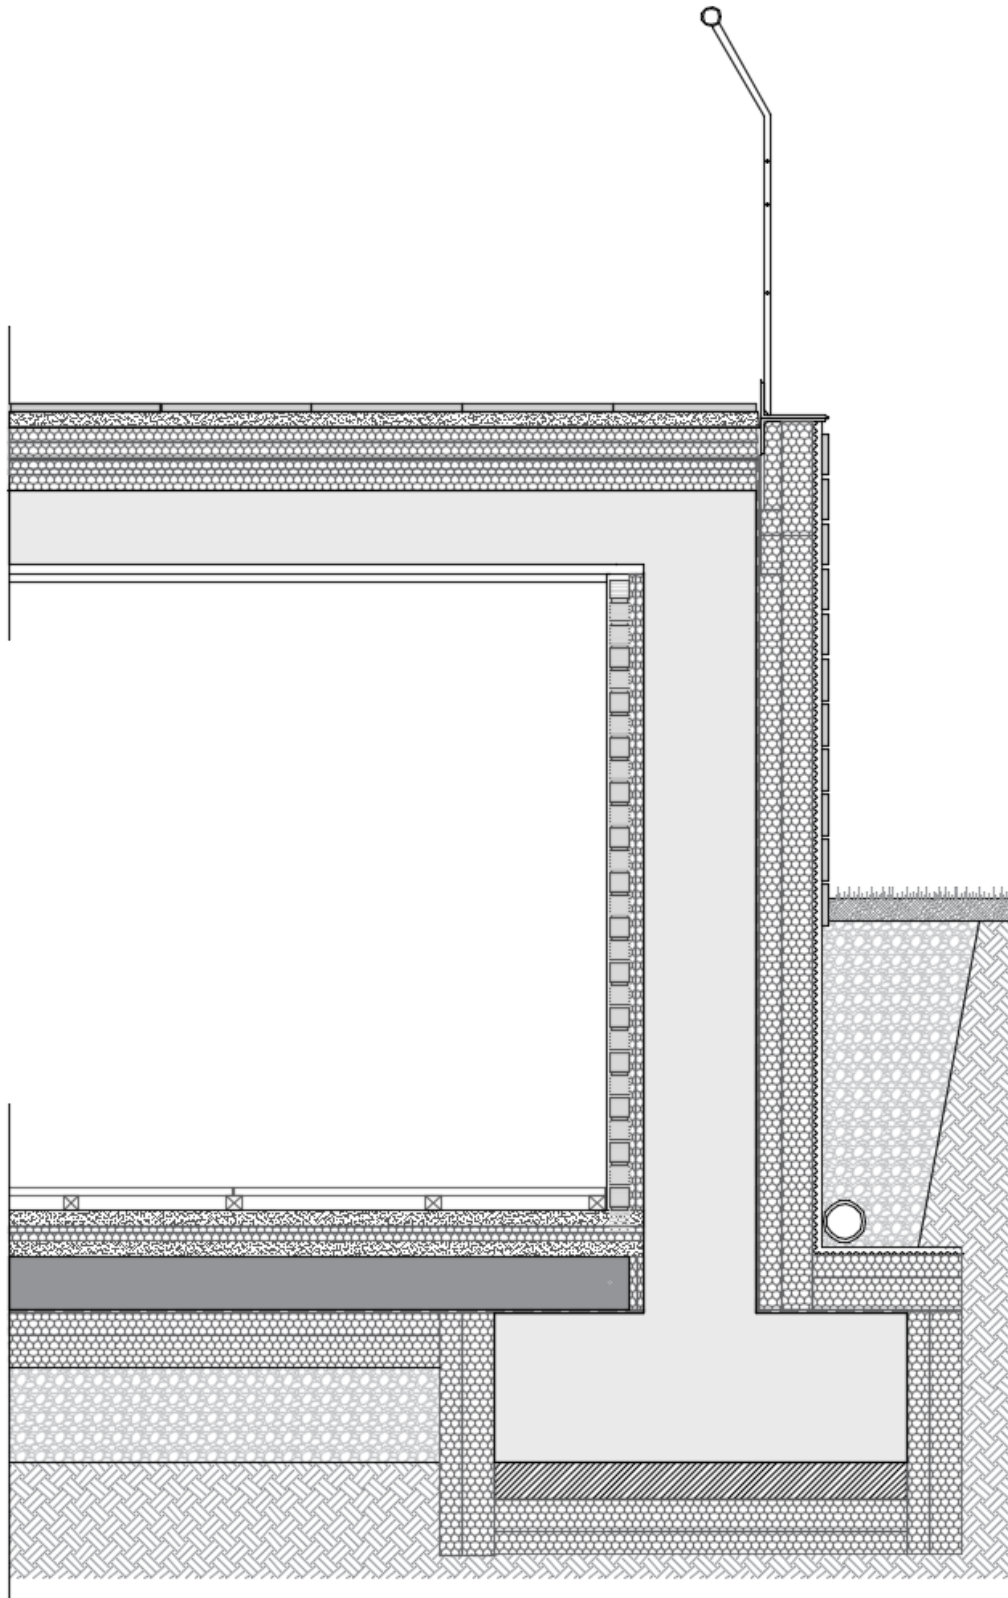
Sección constructiva del estrato inferior tras la optimización. Autor: Elaboración propia
